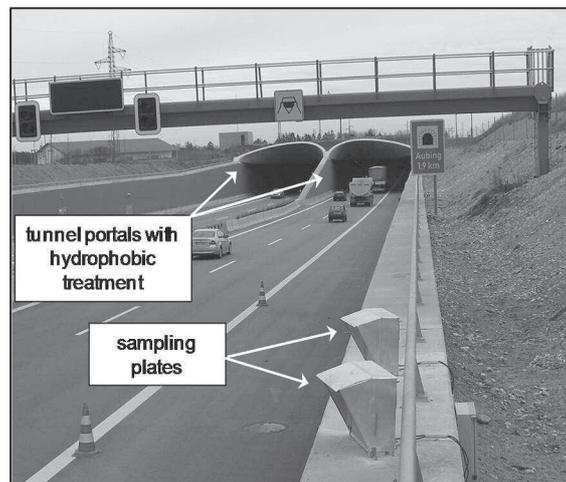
Instandgesetztes, hydrophobiertes Tunnelportal und mit Feuchtesensoren instrumentierte Betonplatten, die mit dem gleichen Material hergestellt wurden, mit dem das Portal instandgesetzt wurde
